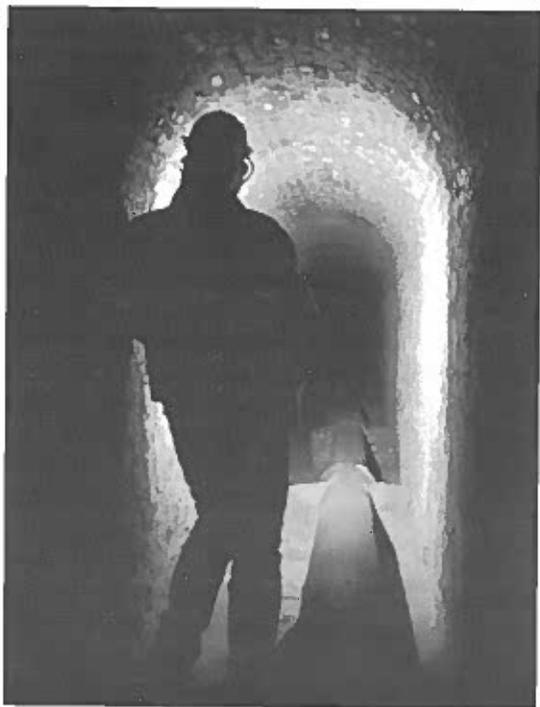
il condotto moderno dell'acquedotto da Le Piagge - CA271LaRM. (foto C. Germani).
